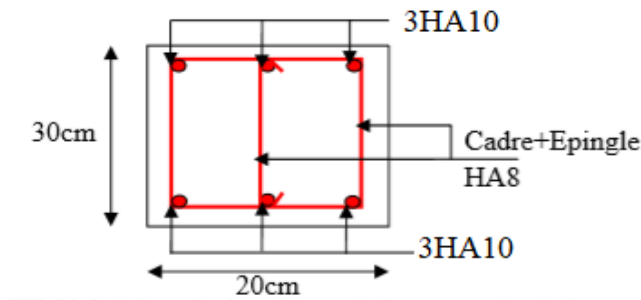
Schéma de ferrailage de la poutre de chaînage.
